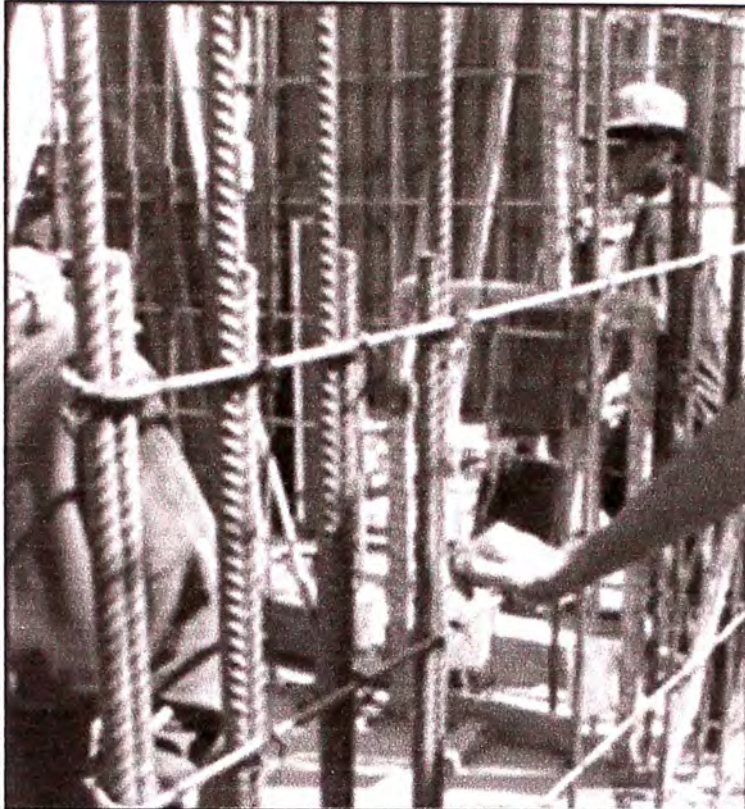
Empalme y reforzamiento vertical en extremos - SMDL
